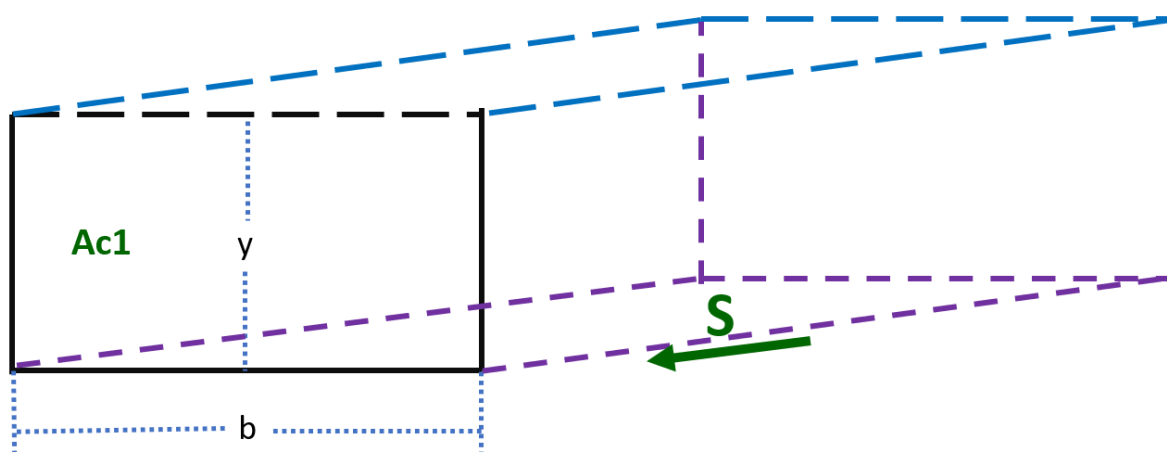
Sección rectangular de un canal donde no se presenta un talud ($z=0$)
